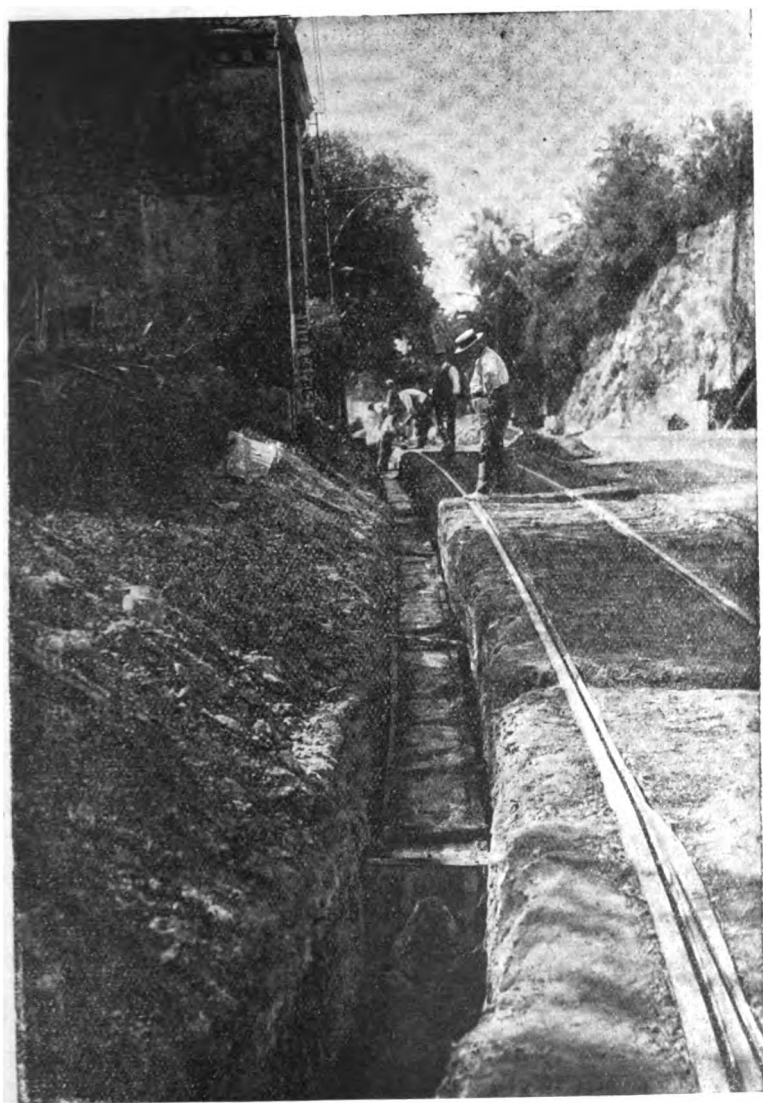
Pose d'une conduite monolithe : portion terminée,
